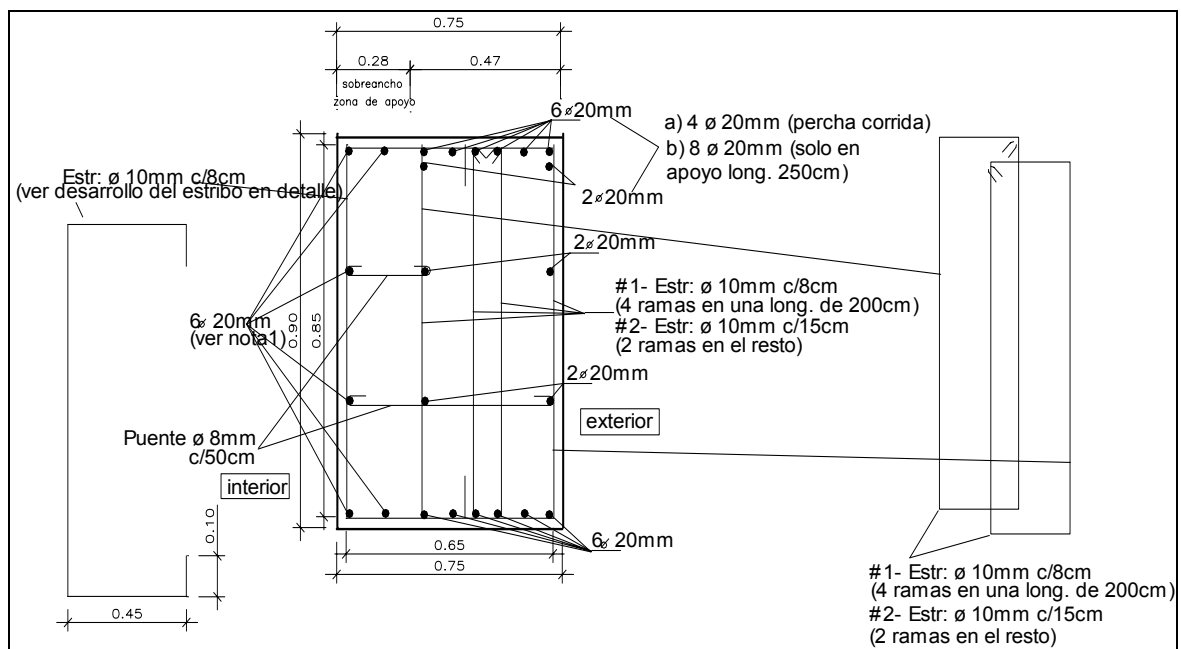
Detalle de disposición de armaduras de vigas soporte de la superestructura, ubicada por encima del sistema de aislamiento, tramo donde se emplaza el sistema de aislamiento central (Ver también Capítulo 9).
